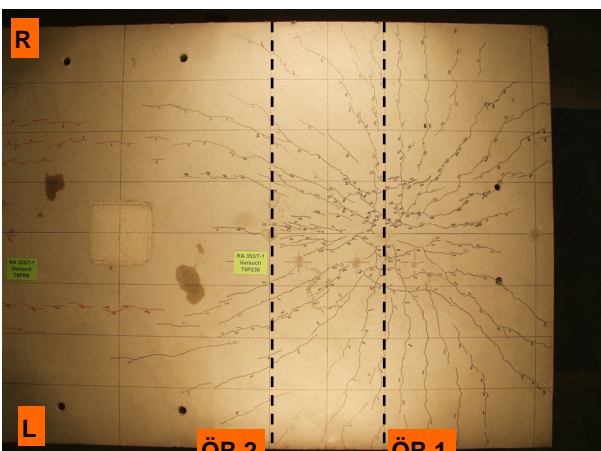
Rissbild auf der Betongurtoberseite
